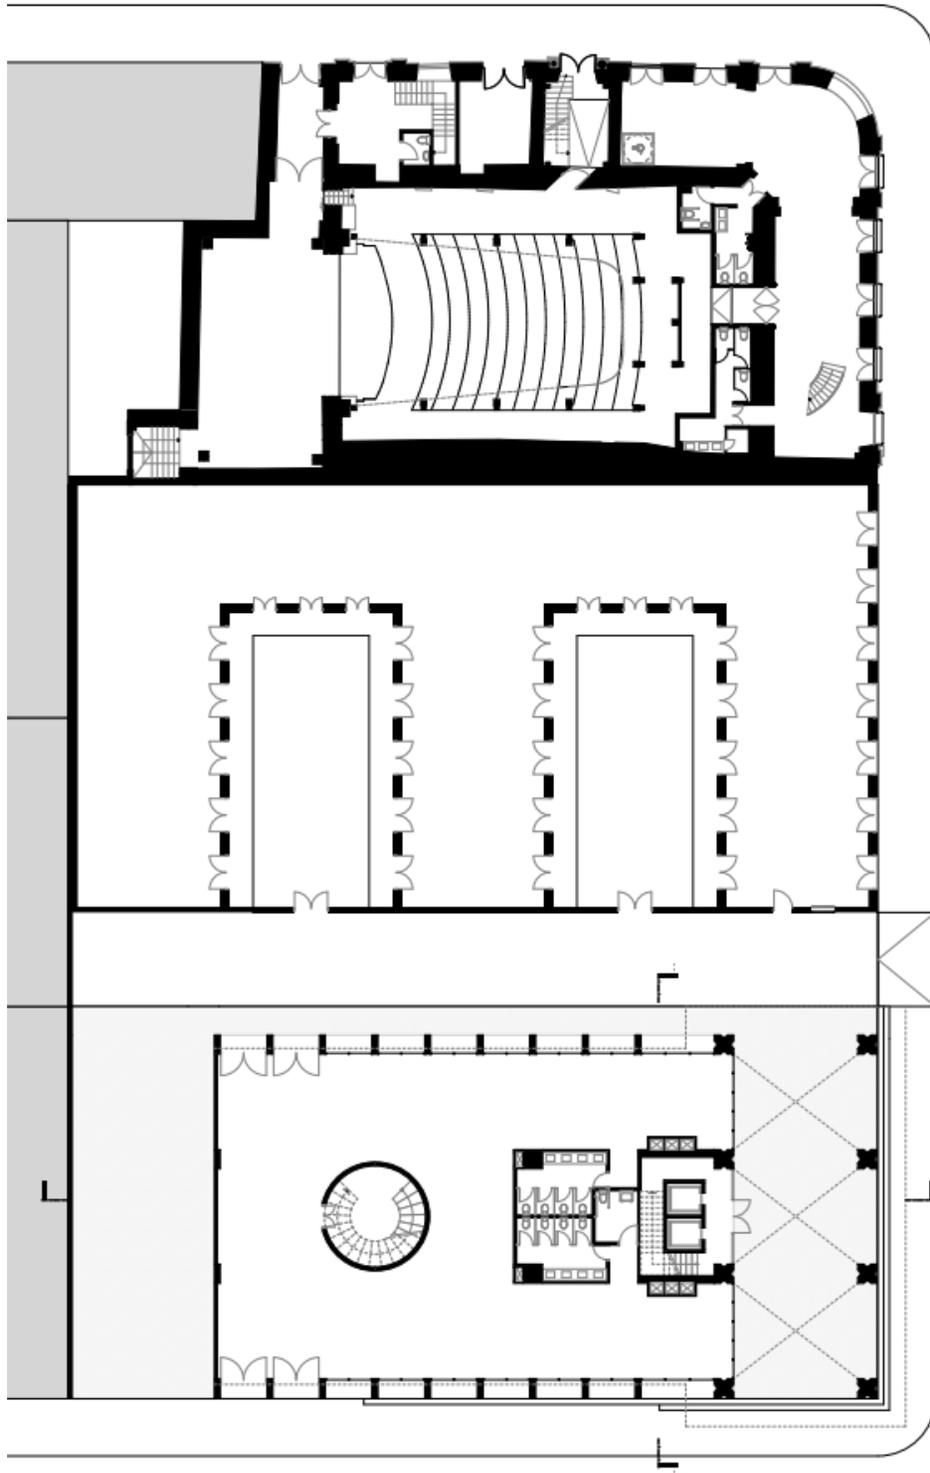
Planta baja general original n ± 0.00. Fuente: Tesistas.
